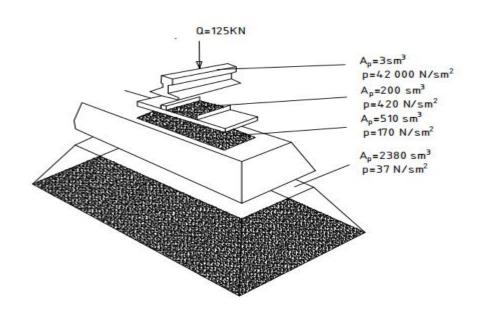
Схемы передачи нагрузки от рельса на подрельсовае основание пути:
